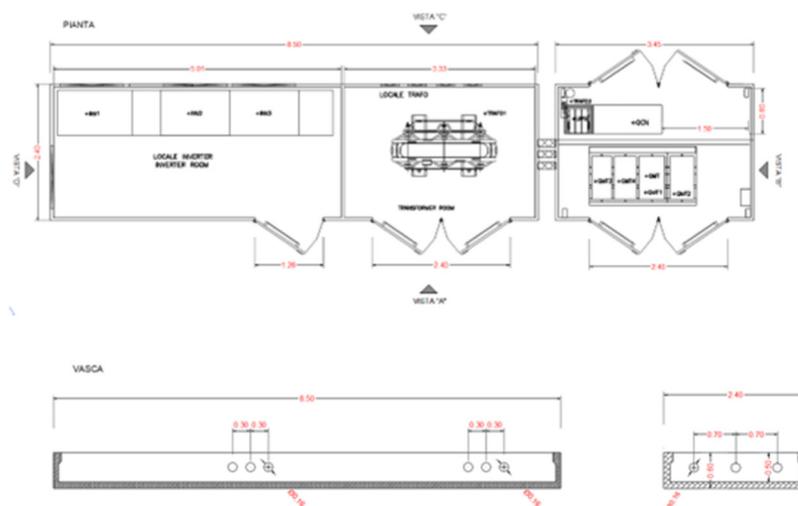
Tipologia di fondazione a vasca per cabinati di conversione: planimetria del cabinato e sezione della fondazione.
